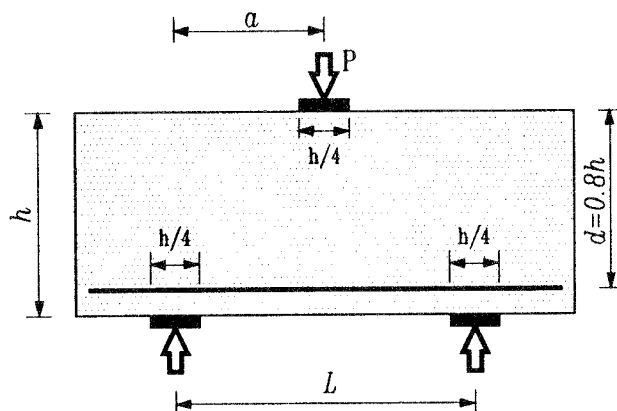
Typische Geometrie eines gedrungenen Stahlbetonbalkens.
